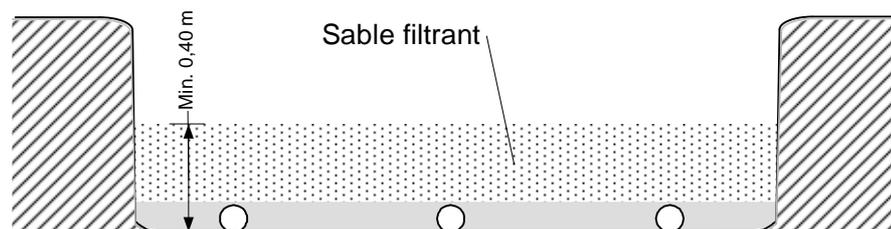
Vue en coupe du bassin avec la couche de sable filtrant
